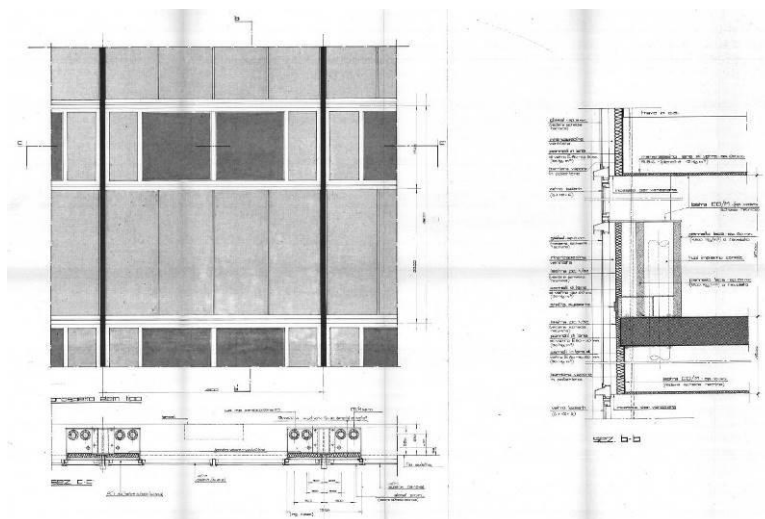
Dettaglio curtain wall – prospetto, sezione orizzontale e verticale dell'elemento tipo (da Progetto Generale di sistemazione per la nuova sede unificata N.I.R.A. nell'edificio N.F.A. della Fiera del Mare di Genova)
